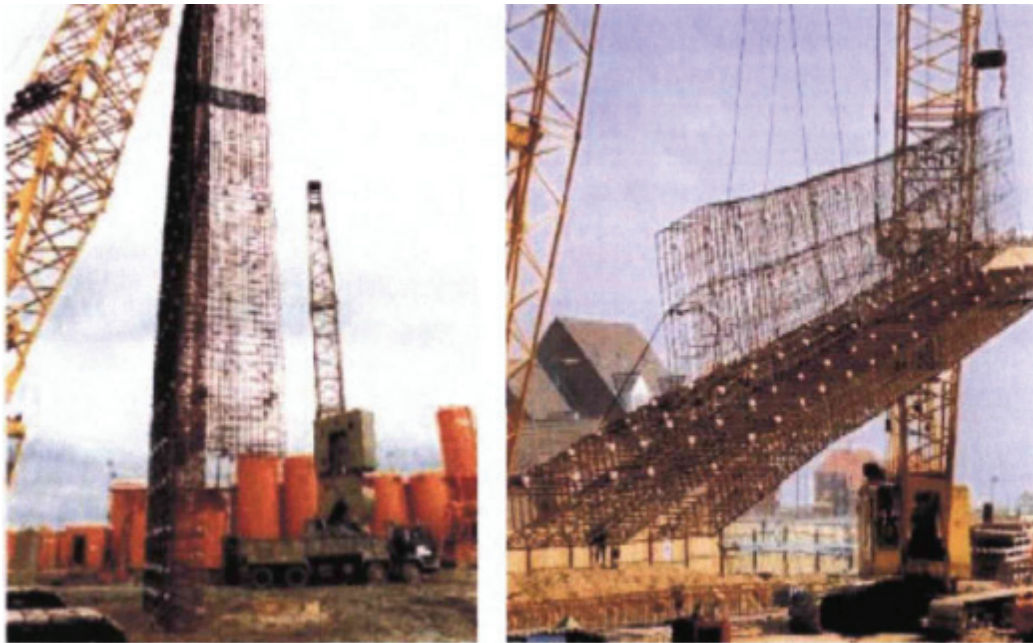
Монтаж Т-образного арматурного каркаса для контрфорсной «стены в грунте» [4].
